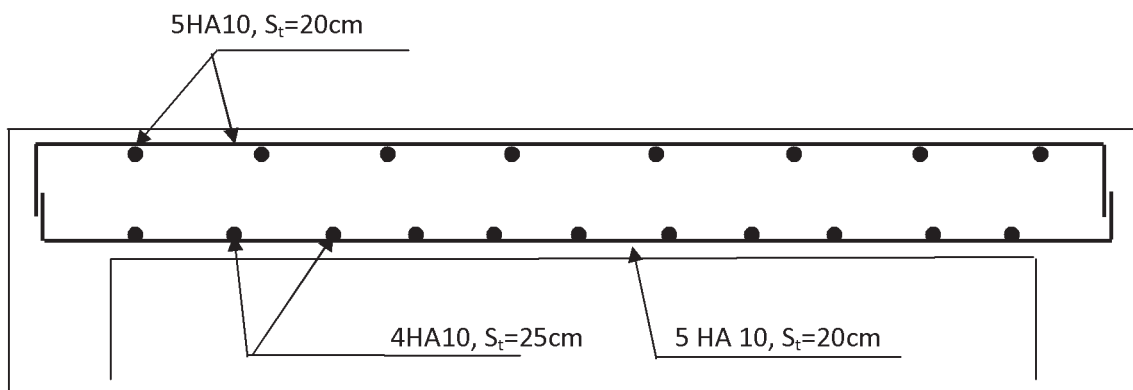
Plan de ferrailage de la salle machine suivant x-x et y-y
